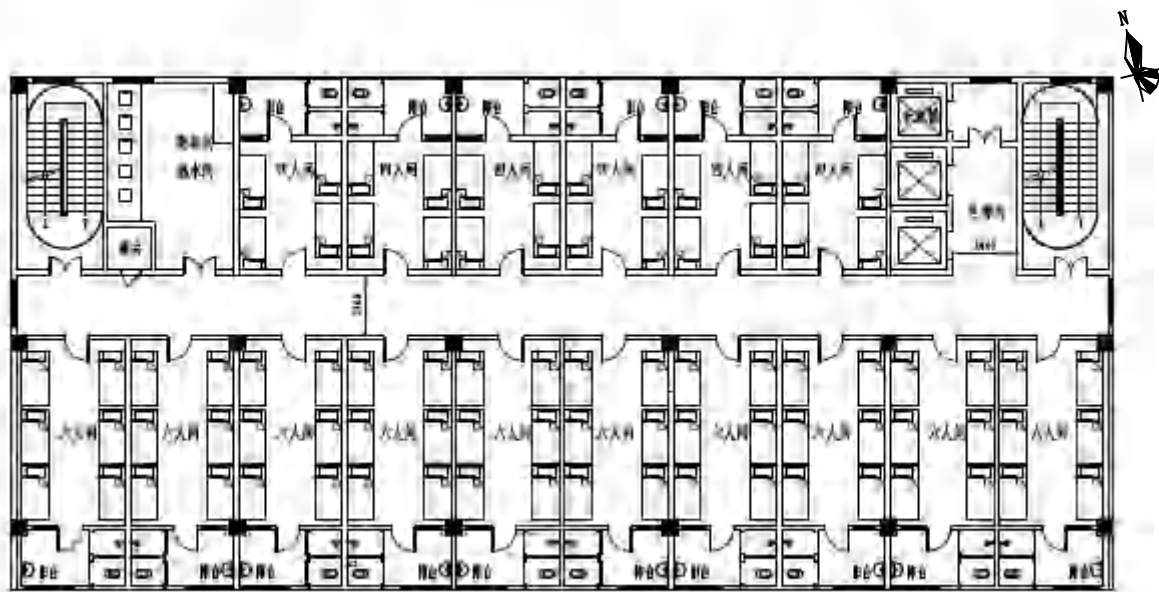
项目宿舍楼二层~六层平面布置图（比例尺：1:297）
